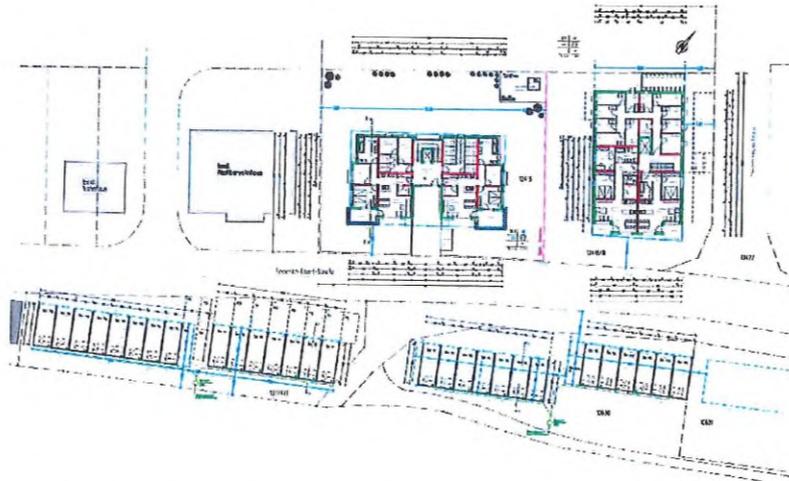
Lageplan der geplanten Baumaßnahme (Quelle: Architektur- und Ingenieurbüro E. Reiss)
